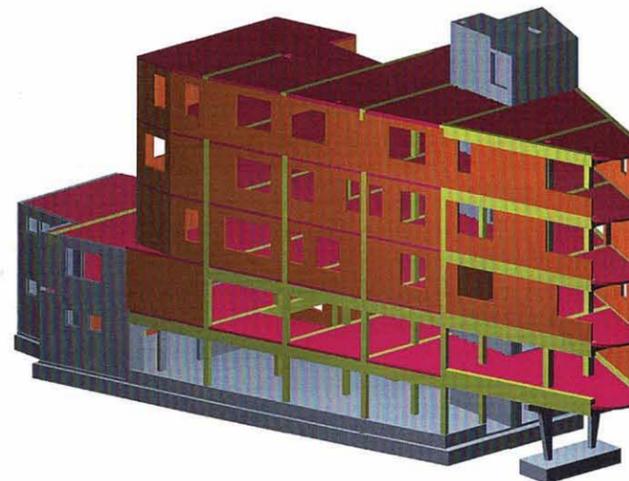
3-D-Isometrie des Holzskelettbau mit BSP-Decken und -Wänden sowie Gebäudeteilen aus Stahlbeton
